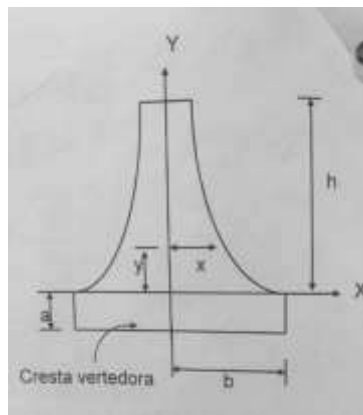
vista en elevación del vertedor tipo sutro.
